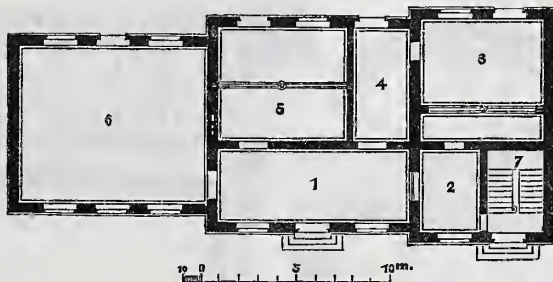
Grundriss vom Erdgeschoss.
